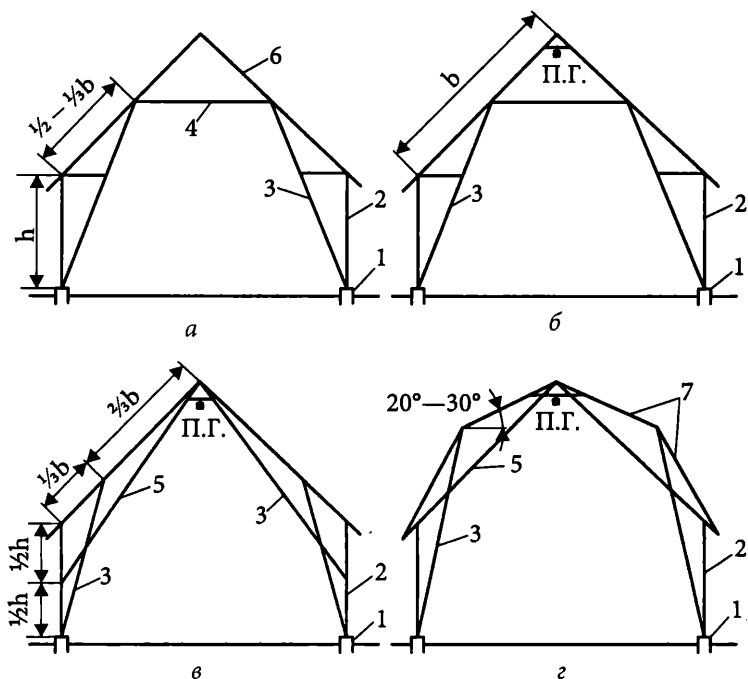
Схемы поперечных разрезов сельскохозяйственных сараев различных конструкций:
